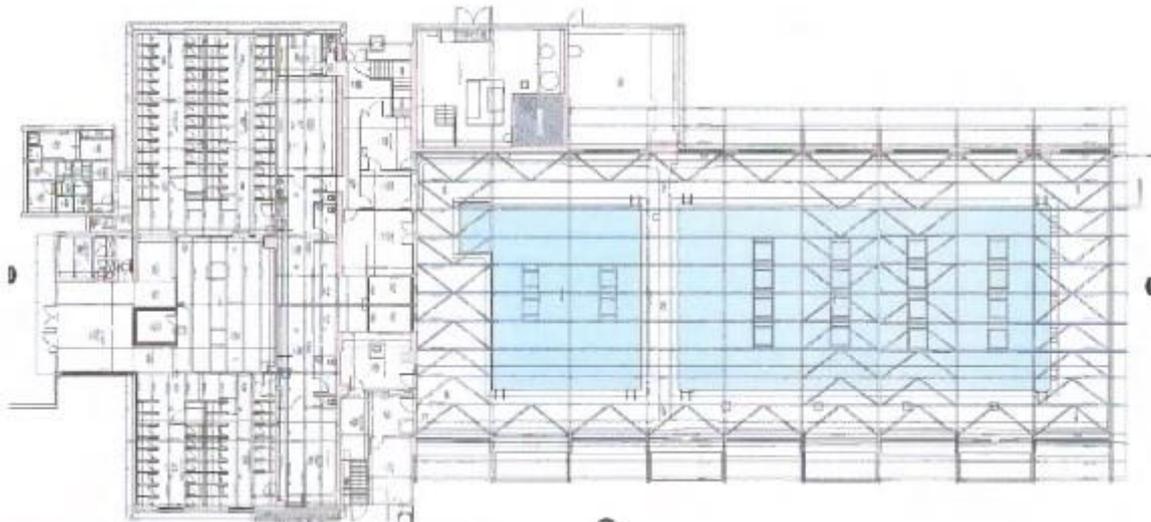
Plan actuel de la piscine (rez-de-chaussée)
